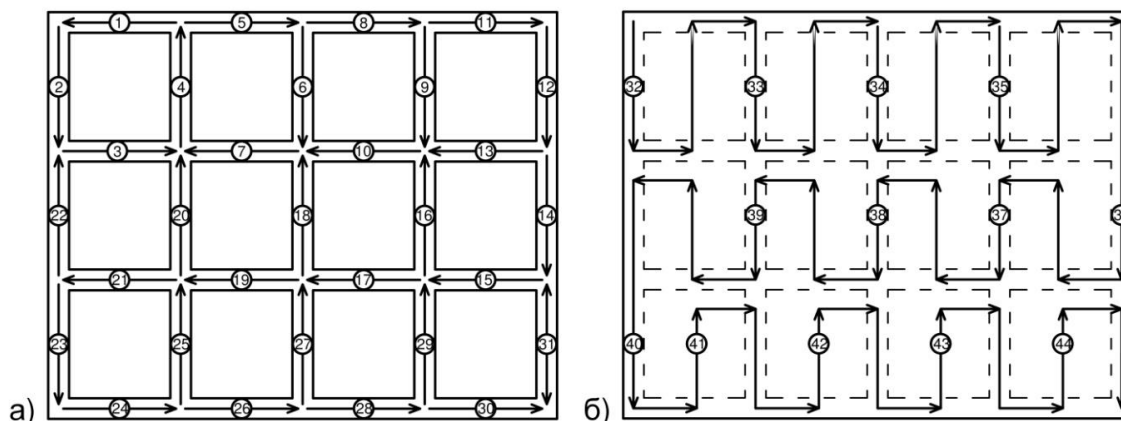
Технологічна послідовність безперервного бетонування плитної прогонової будови у випадку застосування СУБС: а – етапи бетонування нижньої обшивки; б – етапи бетонування решти частини прогонової будови; 1–44 – послідовність укладання СУБС [29]
